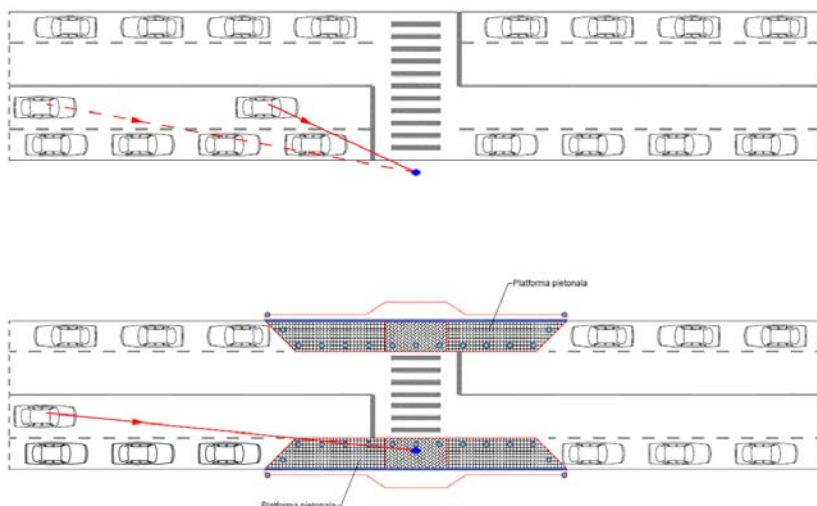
Exemplificare privind asigurarea vizibilităţii la apropierea de o trecere pentru pietoni pentru situaţiile fără şi respectiv cu platformă pietonală
